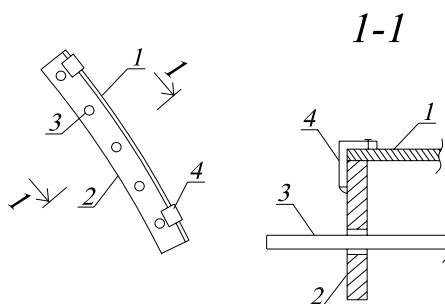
Конструкция крепления ограничительного бортика сектора опалубки оболочки купола: 1 – палуба оболочки опалубки; 2 – ограничительный бортик; 3 – арматура оболочки купола; 4 – крепеж-струбцина.
